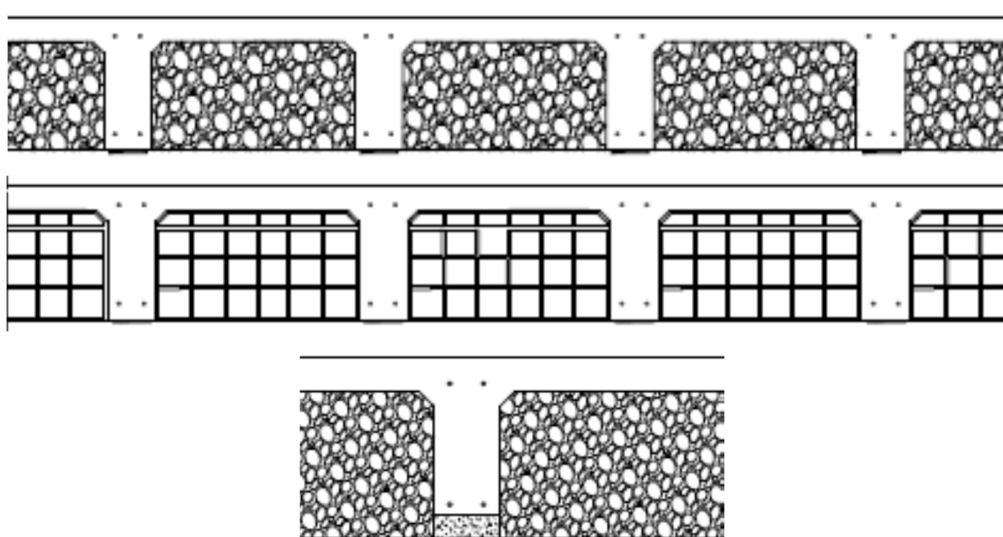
Reforzamiento a flexión con materiales compuestos de placas mixtas con viguetas: sección transversal y detalles
